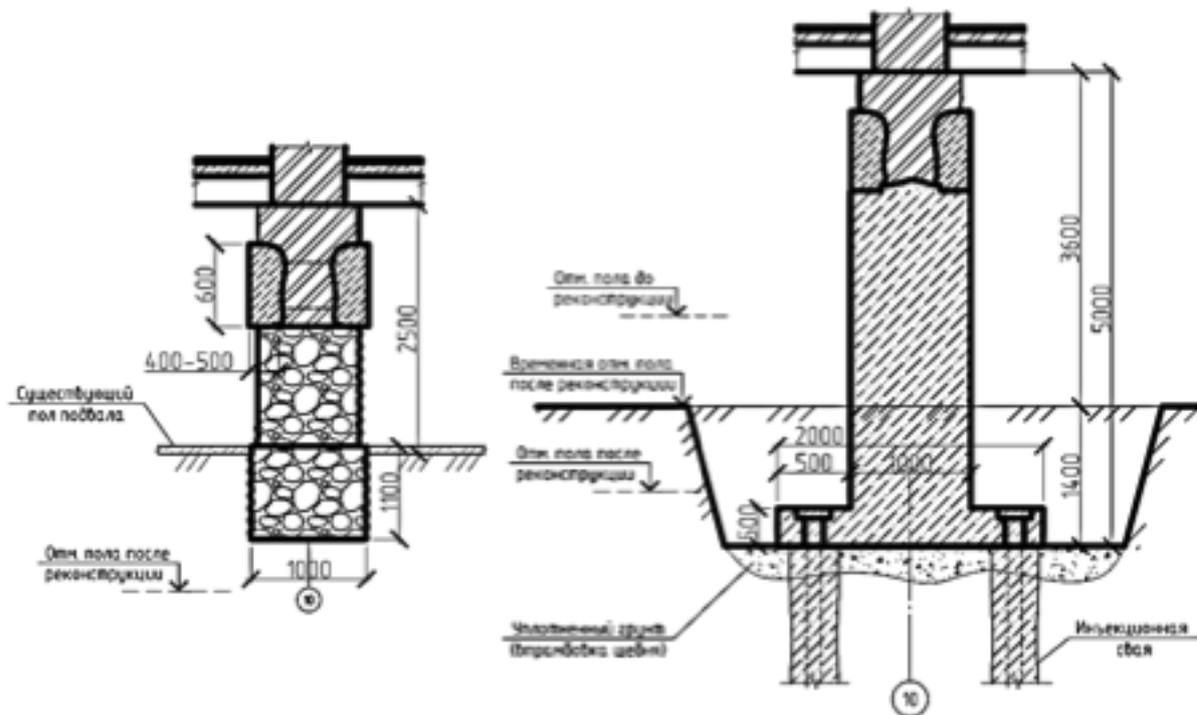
Решение по усилению фундаментов здания на участке в осях А-Д, 1-13 с углублением пола подвала до 4,5 м; – этап № 10 – демонтаж участка фундамента и стены подвала
